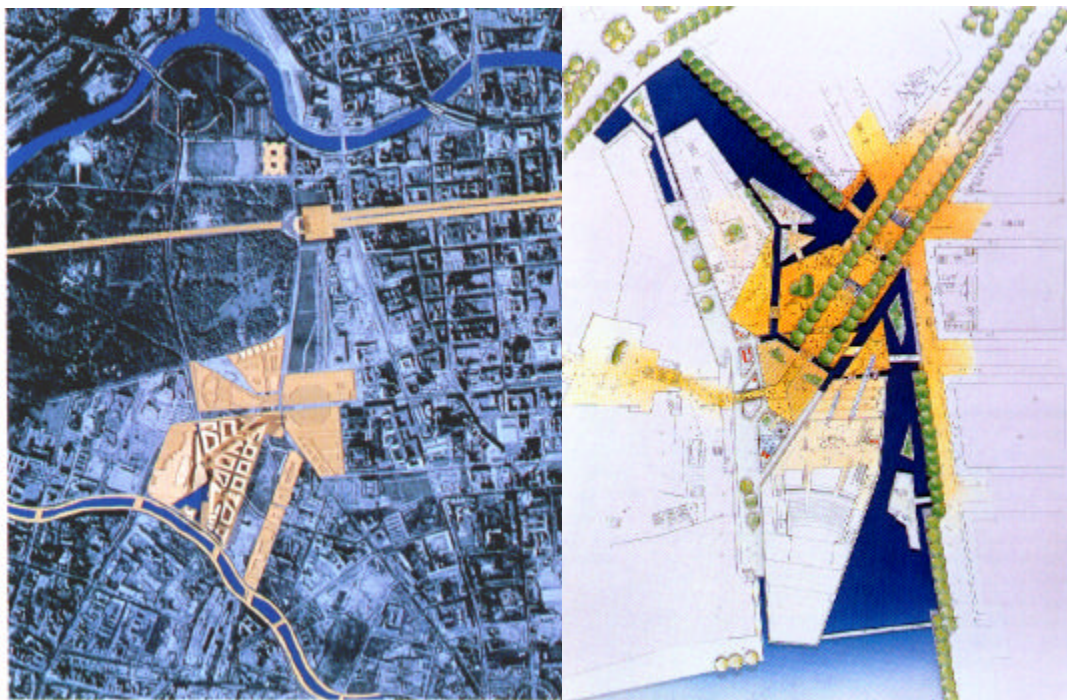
Reconstrução da Potsdamer Platz, Berlim, Alemanha, 1993-2000. Arquitetos: Renzo Piano Building Workshop.
